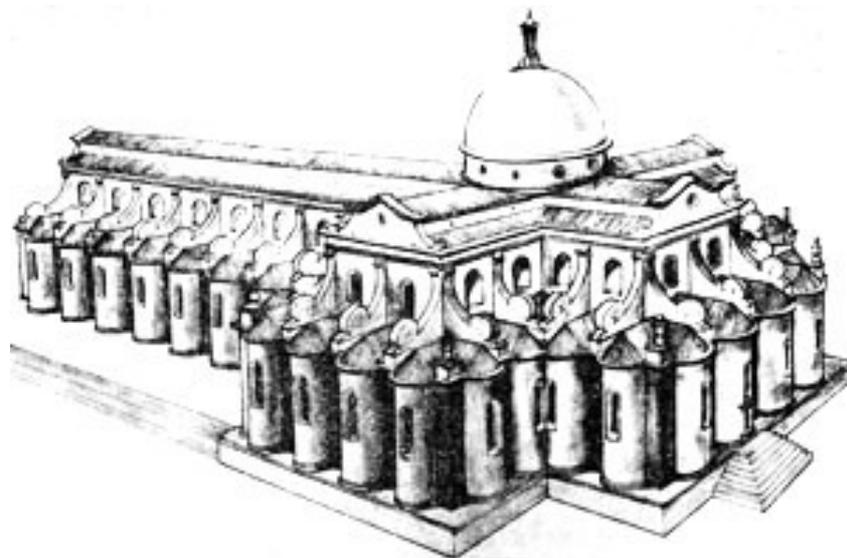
Reconstrucción de la maqueta de Brunelleschi, Santo Spirito.
